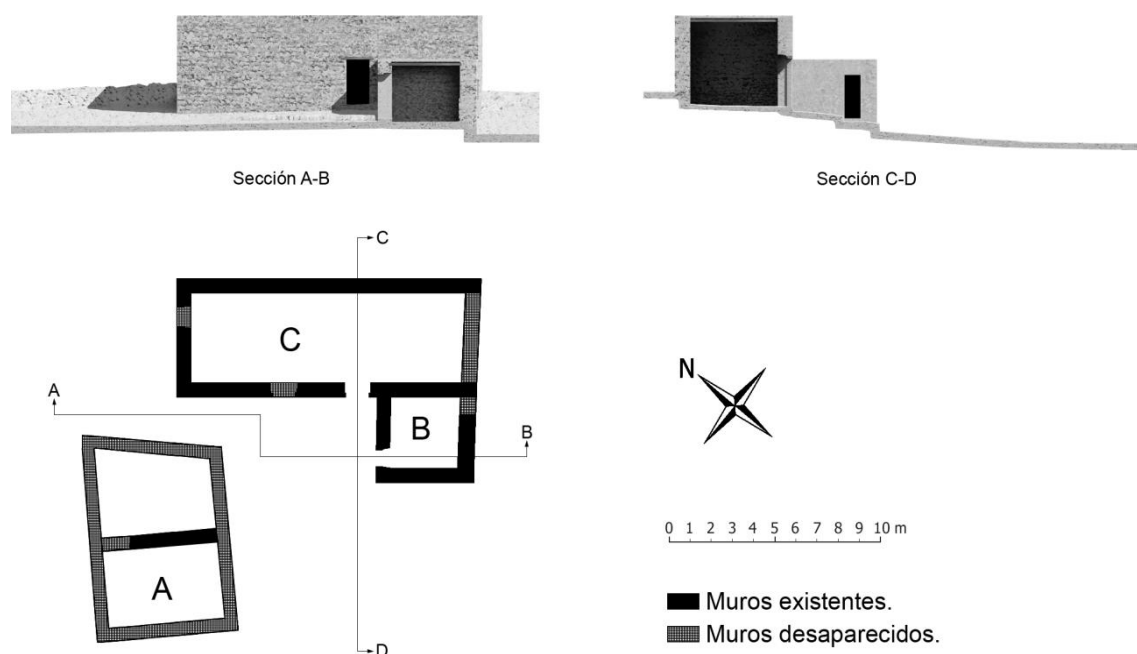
Fase 2. Alzado, sección y planta del Raal Daut o Puig Almostem en época islámica.
